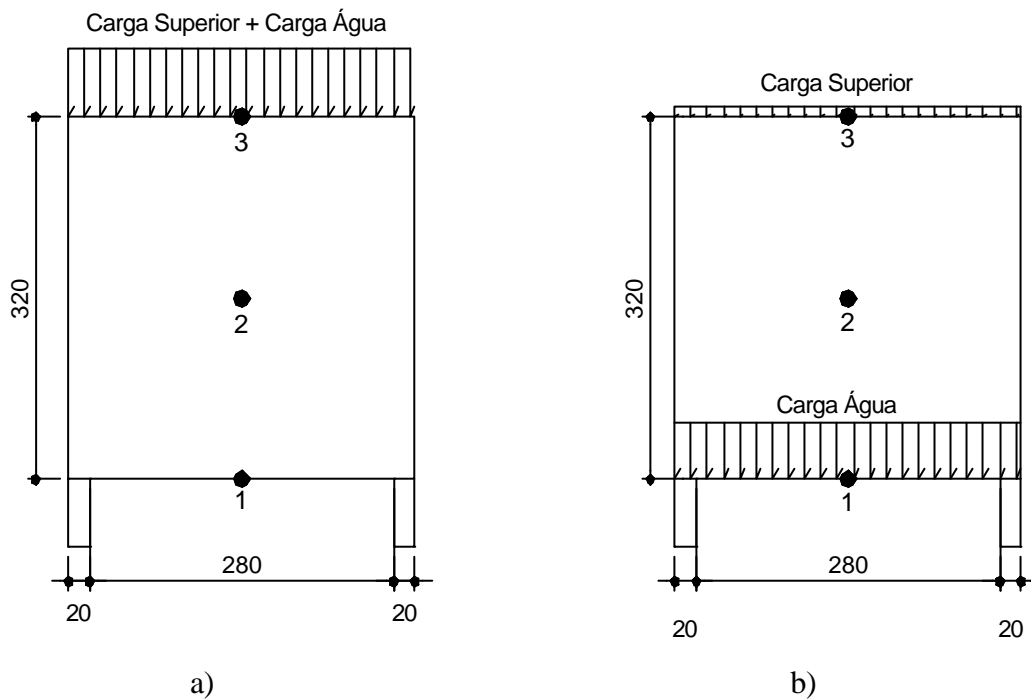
a) Viga-parede nº 1, Caso A ; b) Viga-parede nº 1, Caso B.
